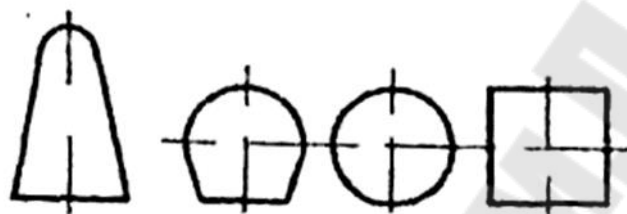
Форма поперечных сечений выработок подземных хранилищ
